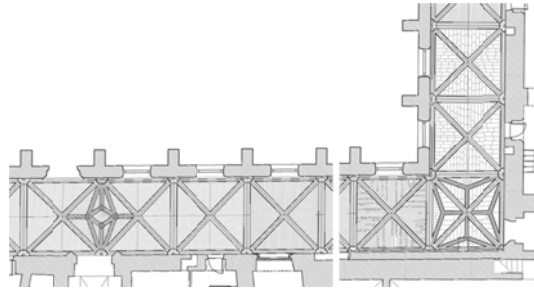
Despiece de plementería en distintas bóvedas, planta. Fuente: Eduardo Barceló.
